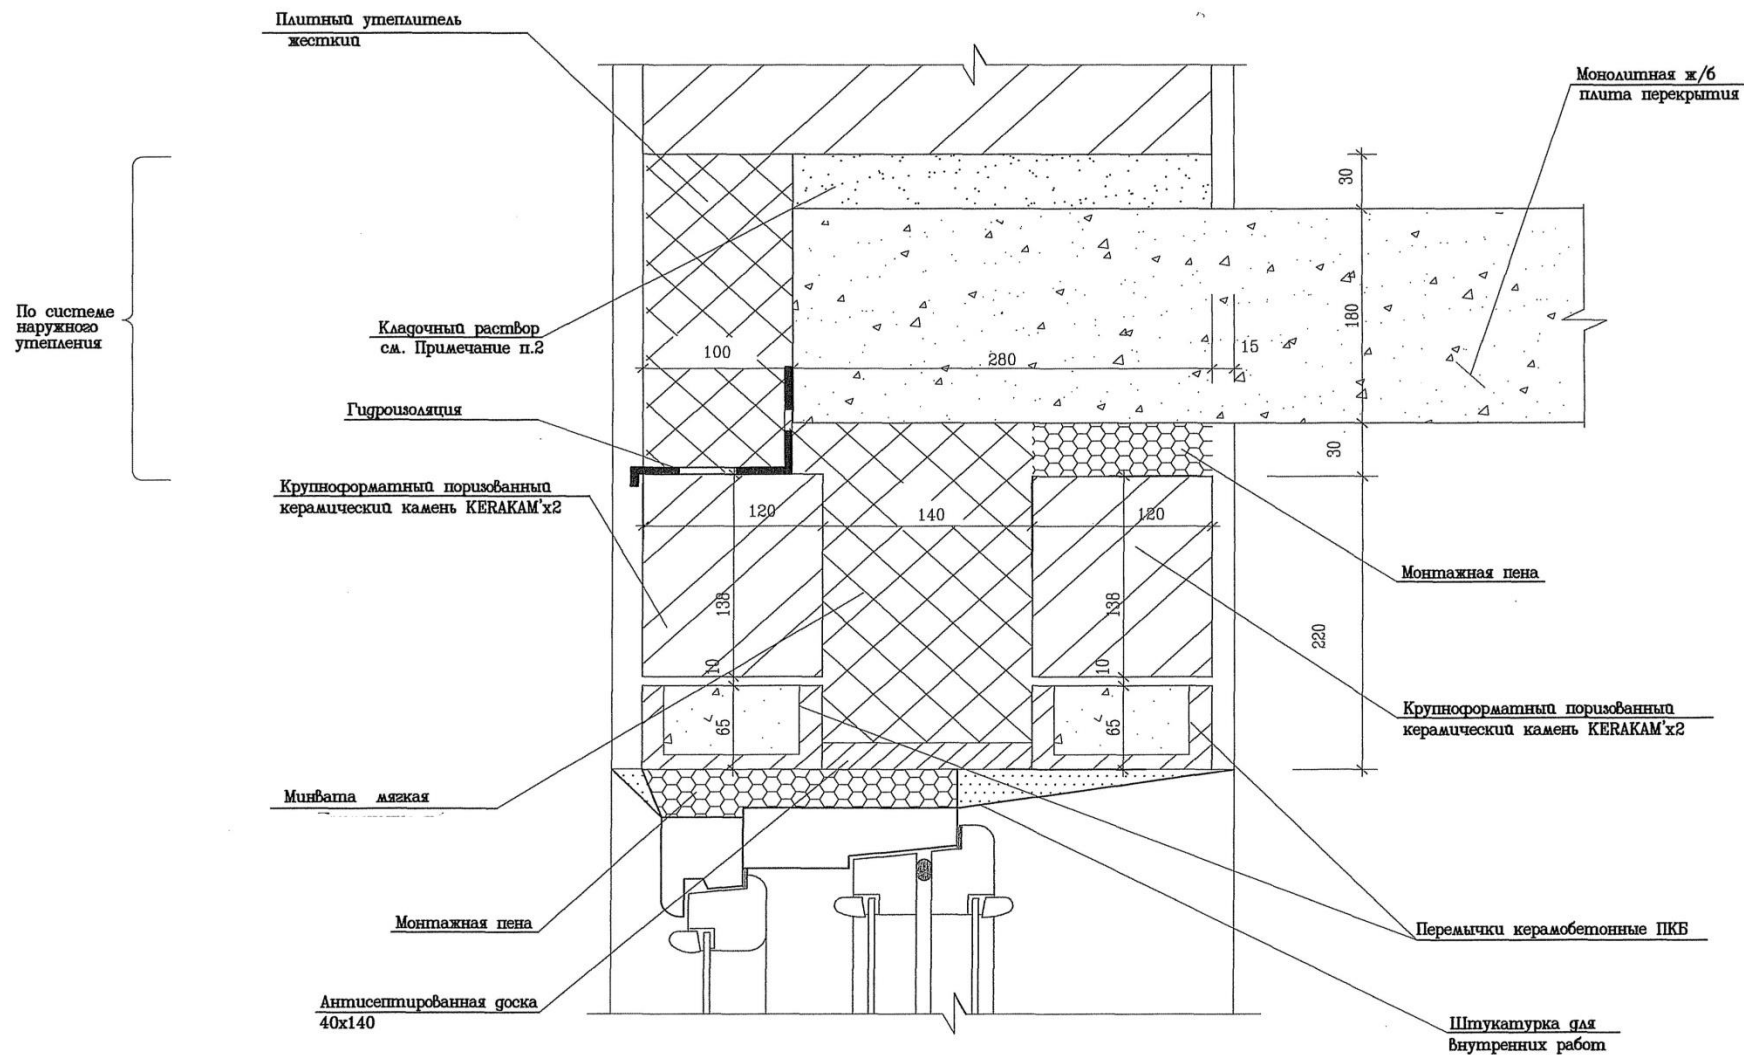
Узел 3 (стена с плоской плитой перекрытия)
